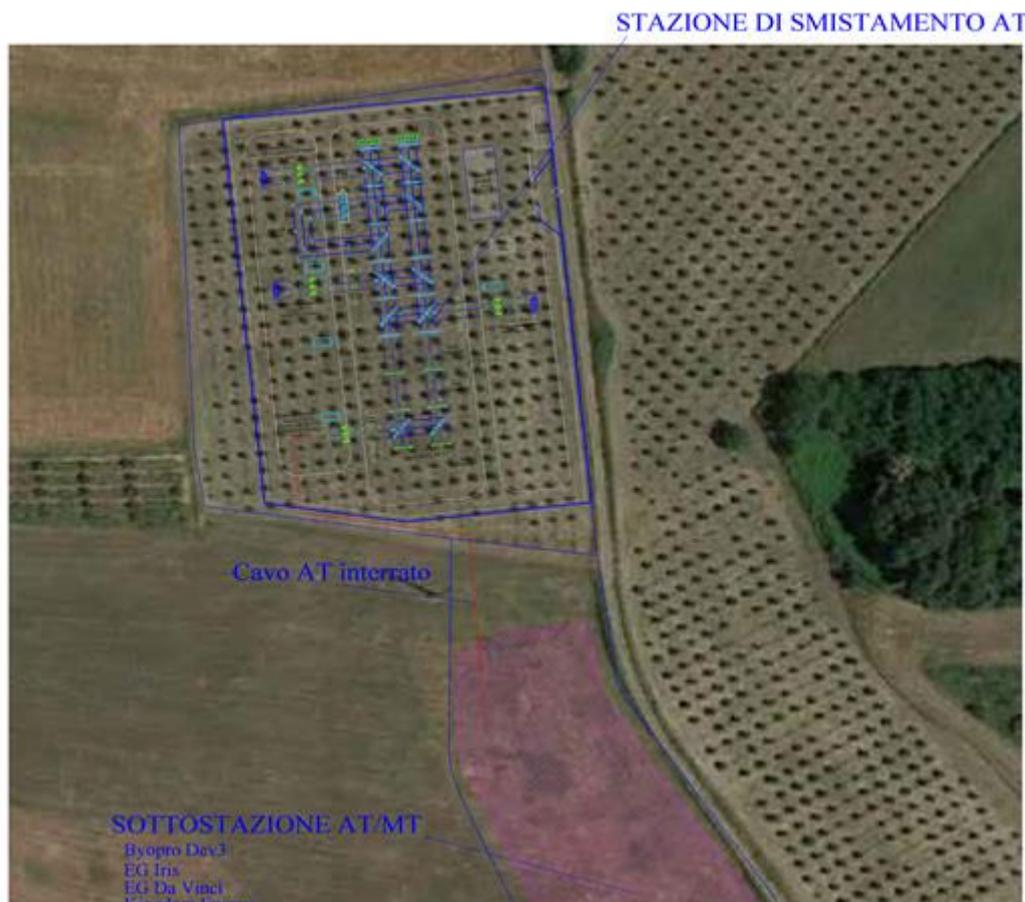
Planimetria Stazione Terna "Valentano" su Ortofoto
